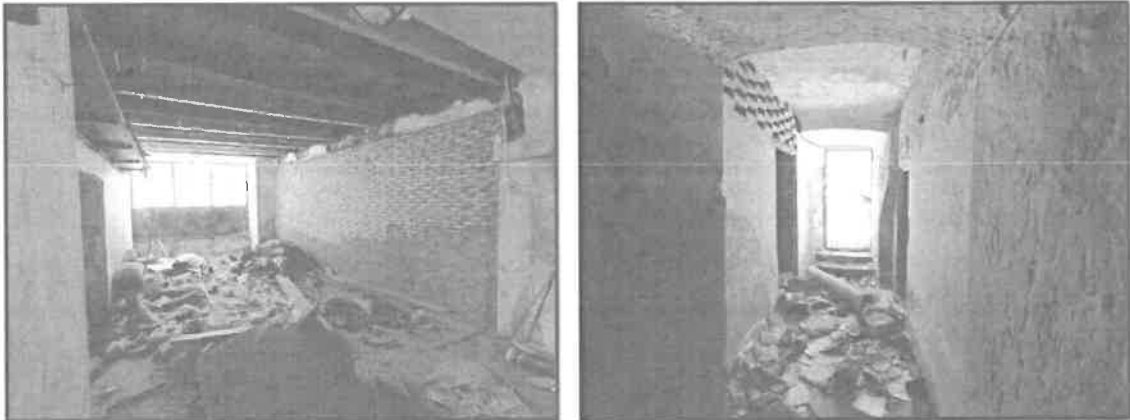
8 locale al piano terra e corridoio al piano terra
